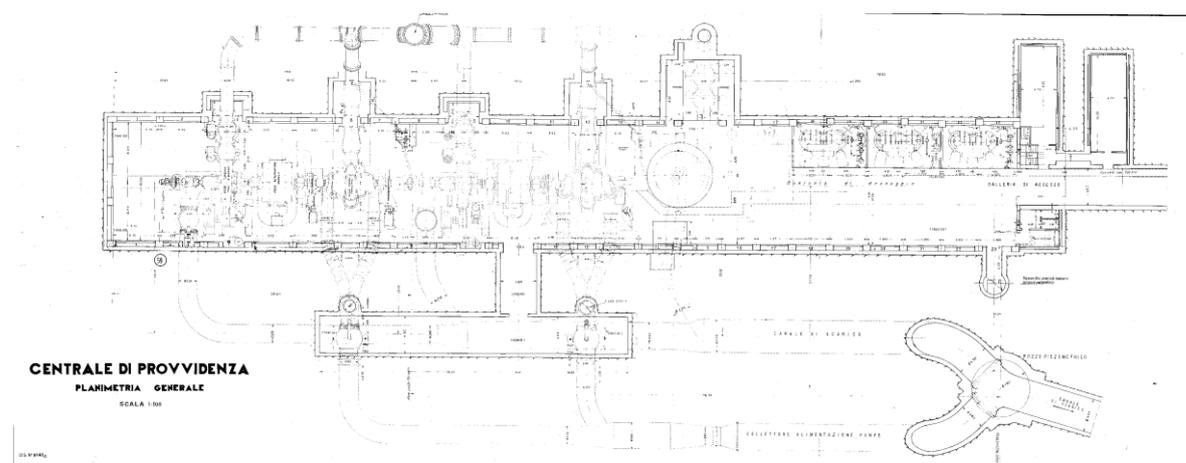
Centrale di Provvidenza esistente – planimetria generale
